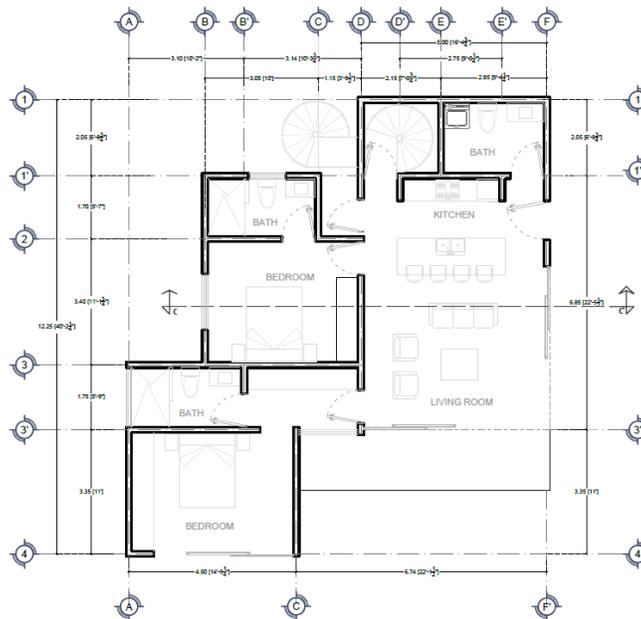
Planta arquitectónica del departamento del Edificio 3.
